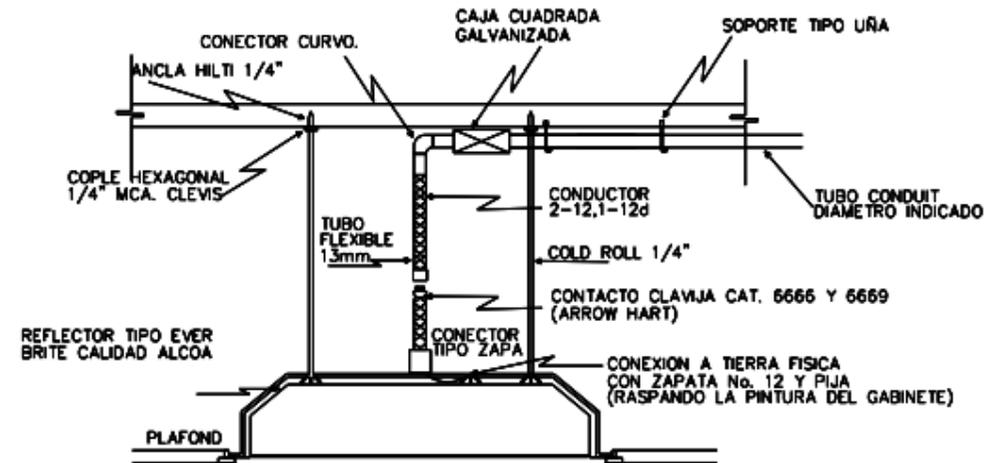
Detalle para la colocación de luminarias de 60 x 60 cm.
